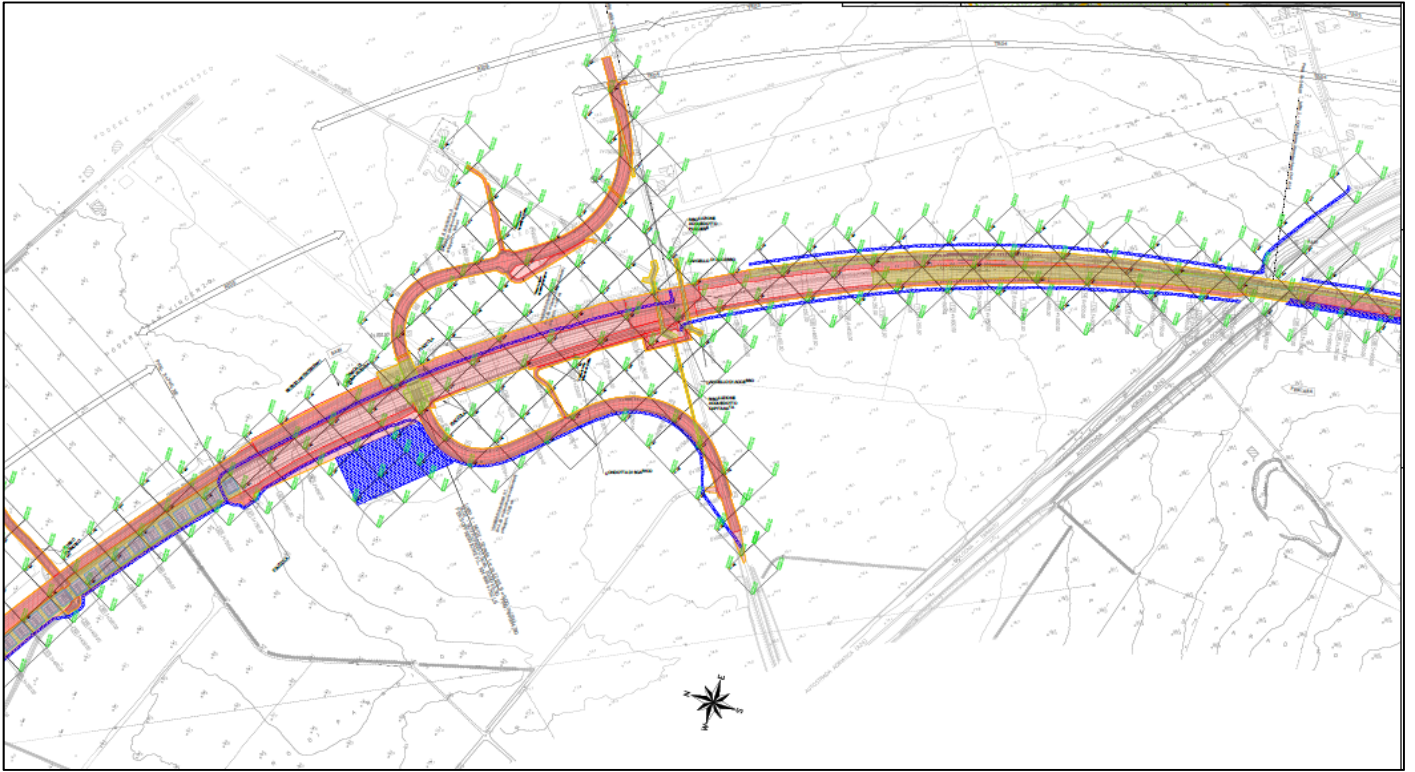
Stralcio Planimetrico tav3/4 delle aree da assoggettare a B.O.E
